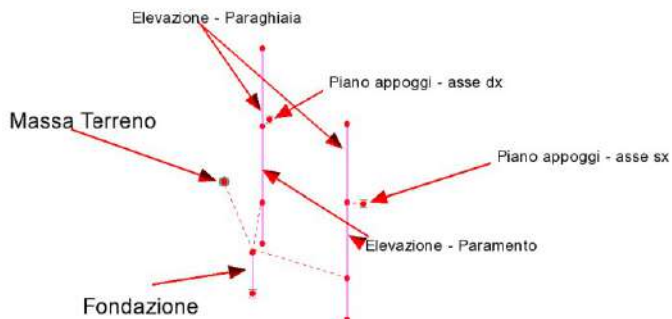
Modellazione spalla - layout E.F.
